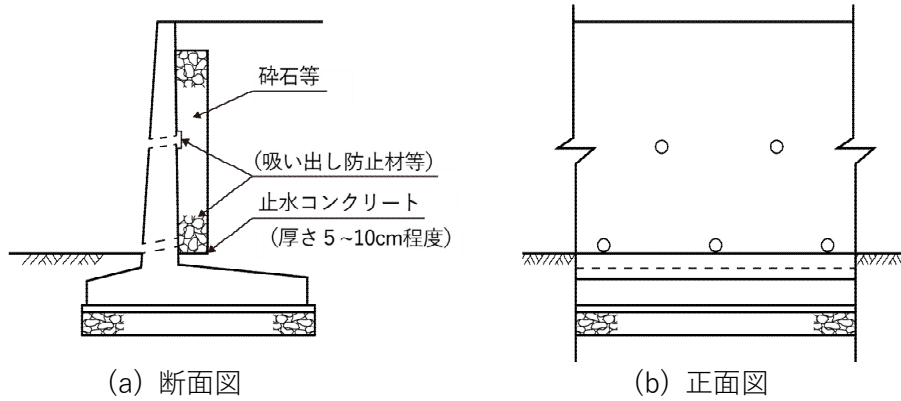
鉄筋コンクリート擁壁の断面図及び水抜穴設置図
